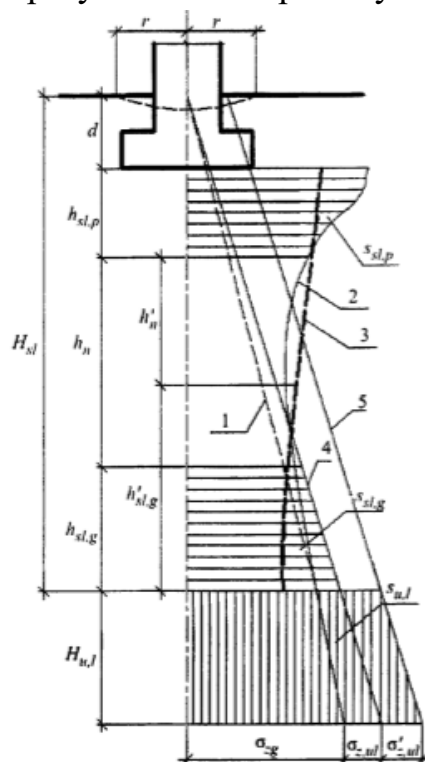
Схема к расчету просадок основания фундаментов
